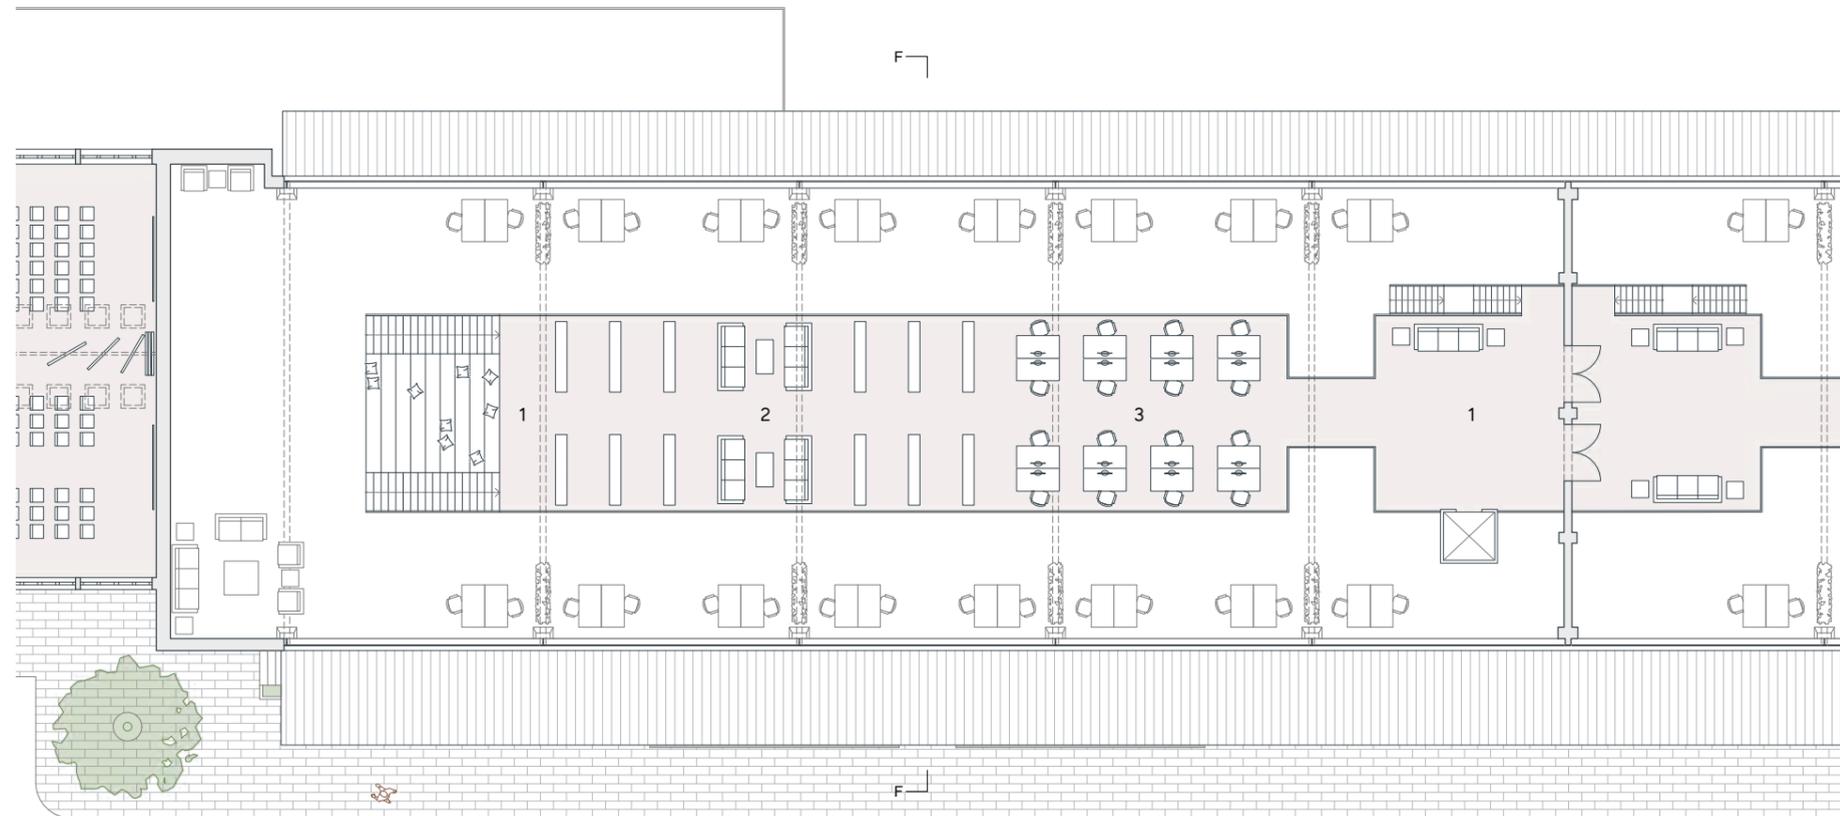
Stückgutschuppen: Bauliche Veränderungen, Co-Working-Space, Halle 1, Obergeschoss M 1:250
